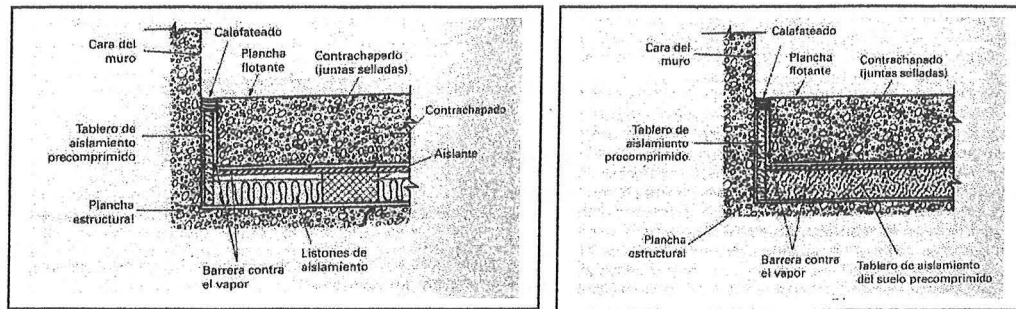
Ejemplos de construcción de una losa flotante, a) sobre aisladores comercializados, b) sobre una manta de lana de roca o fibra de vidrio.
